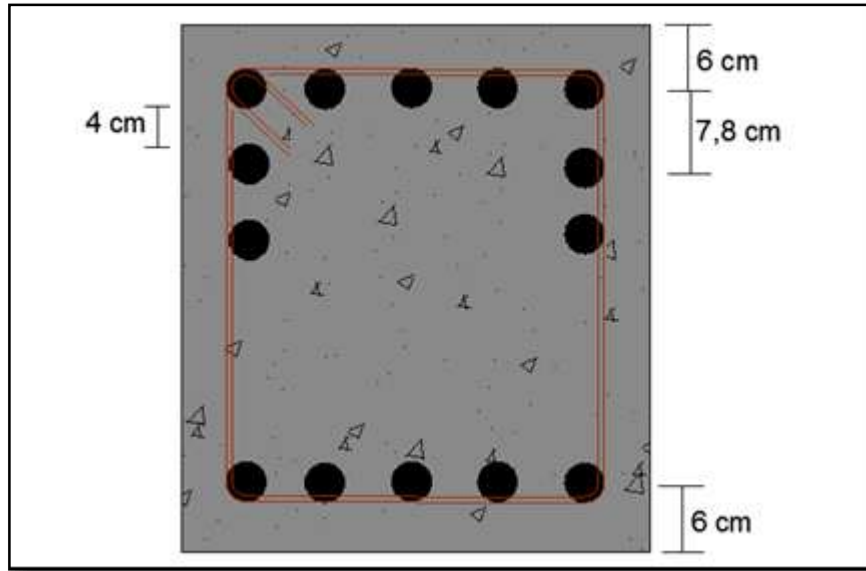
Sección transversal de viga de apoyo. Fuente: Autor de la pasantía.
